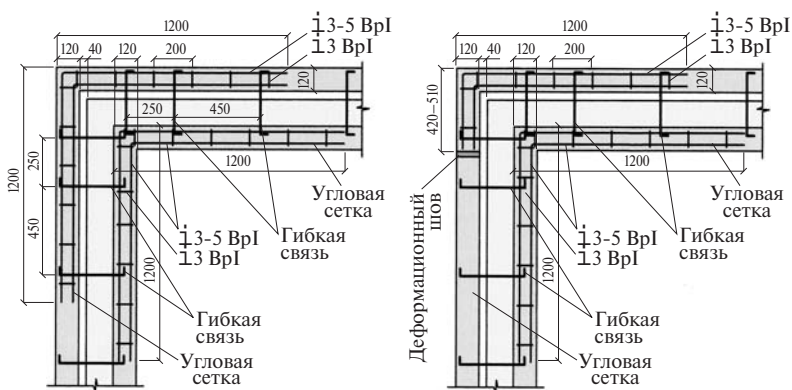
Схема установки в углах стены гибких связей и связевых сеток
